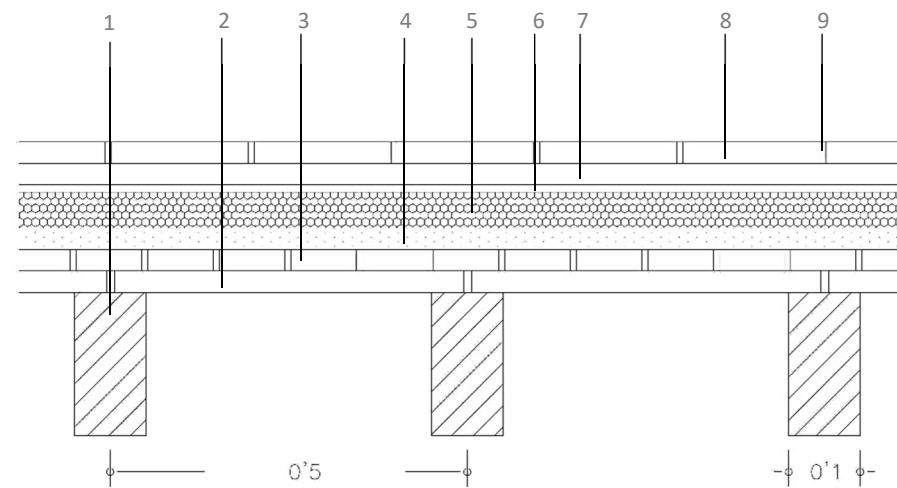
Detalle constructivo fachada de la galería. Fuente: <E. Ripollés>.
